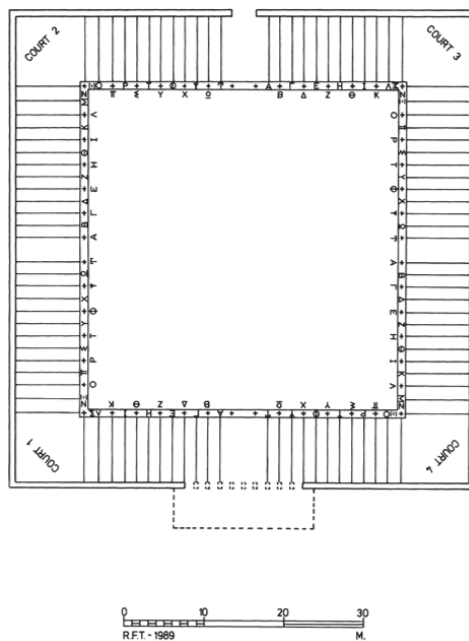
Planimetria dell'Edificio con Peristilio con le ipotetiche corti dei tribunali secondo R.F. Townsend (da TOWNSEND 1995b).
